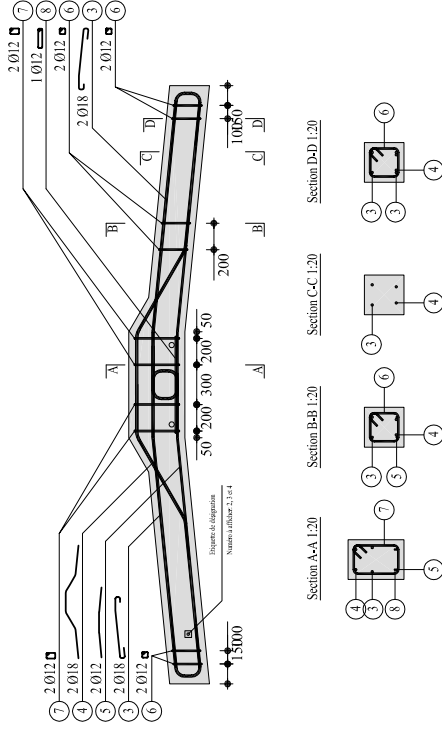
Plan d'armature des spécimens DT2, DT3 et DT4 ; cotes en [mm].
